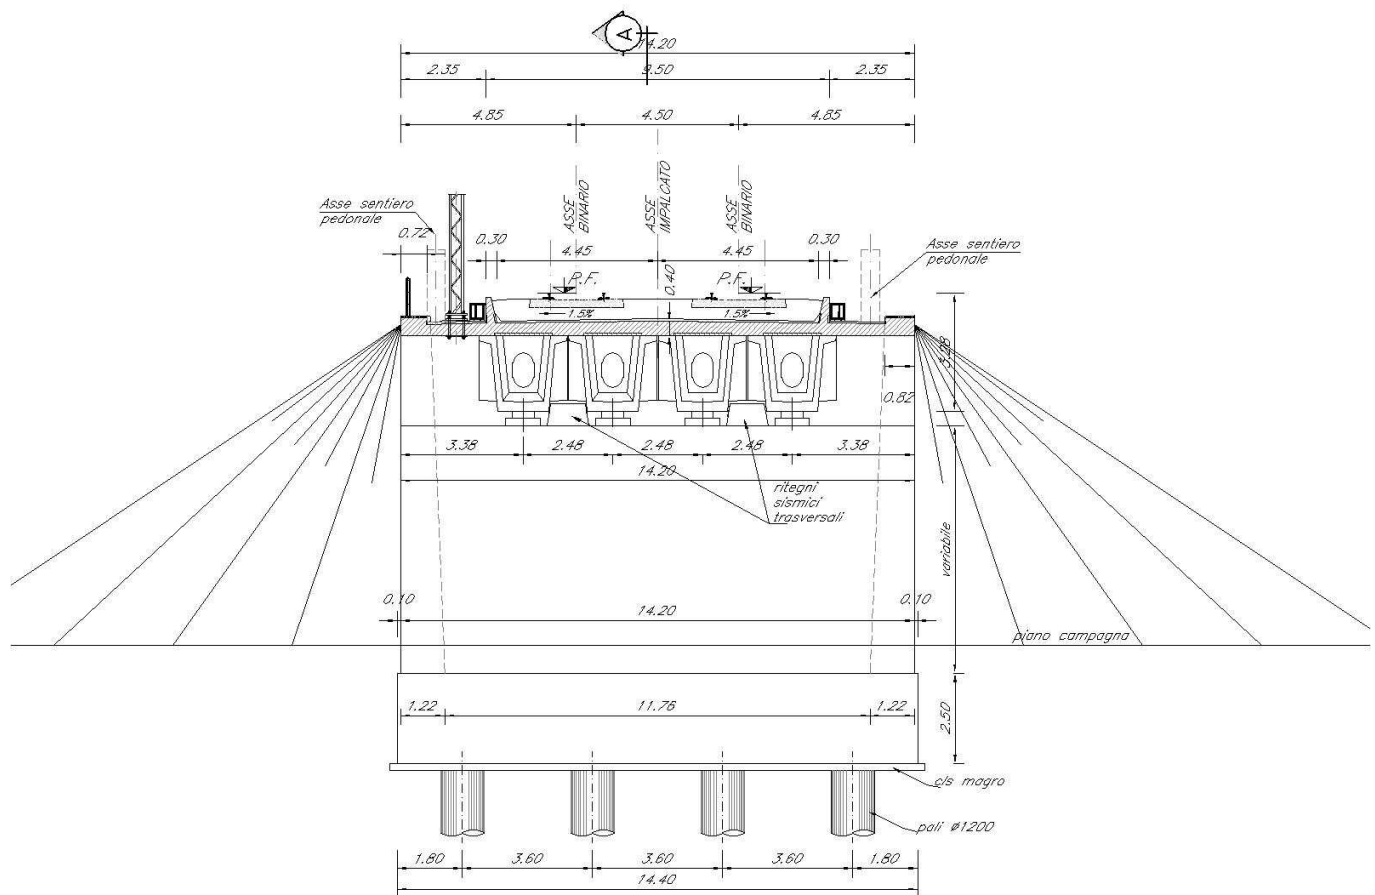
Sezione longitudinale della spalla tipo.
